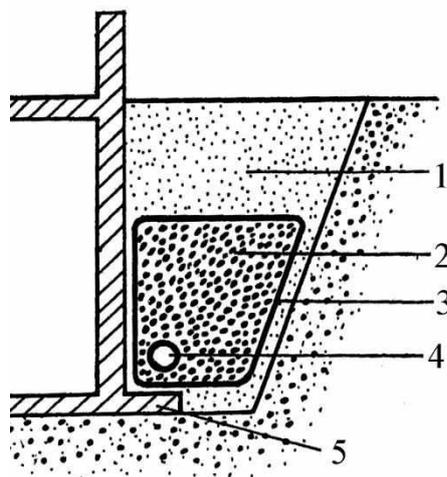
Схема прифундаментного дренажа с геотекстилем
